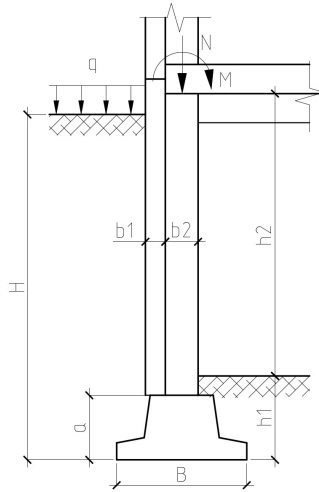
Схема гибкой железобетонной наружной стены (панели) подвала
